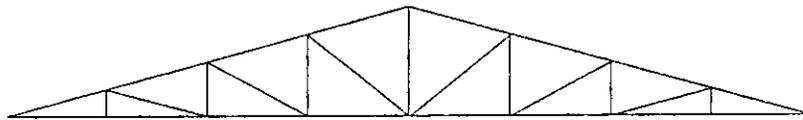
TIPOS DE ARMADURAS MÁS UTILIZADOS
